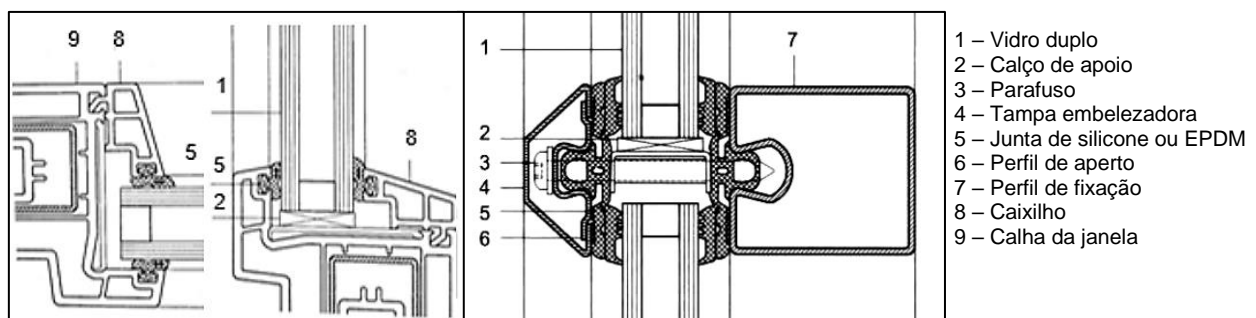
Sistema de fixação contínuo (fachada em cortina) (adaptado de [43]).
